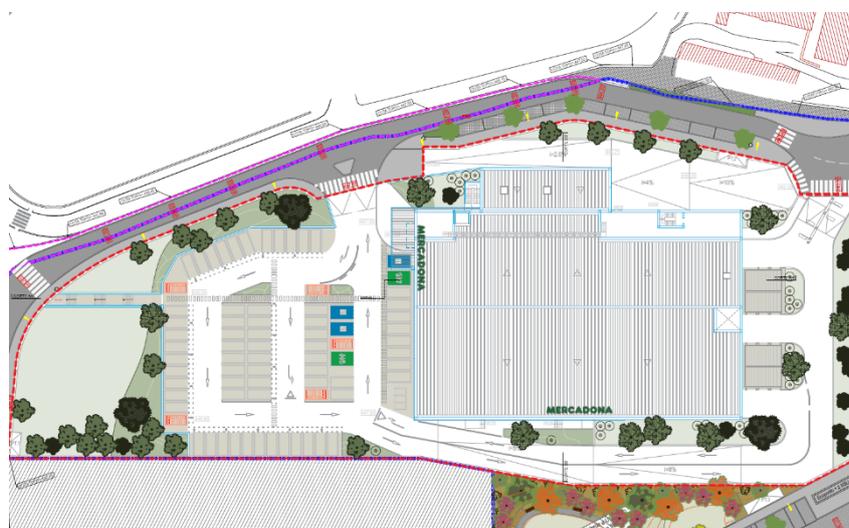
Extrato da Planta de Implantação (Fonte: EIA – Anexo II, junho 2023)
